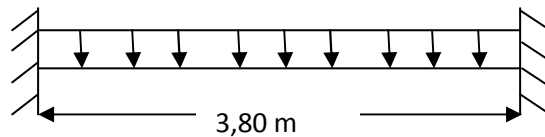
Schéma statique de la poutre palière ssol 1 et 2
